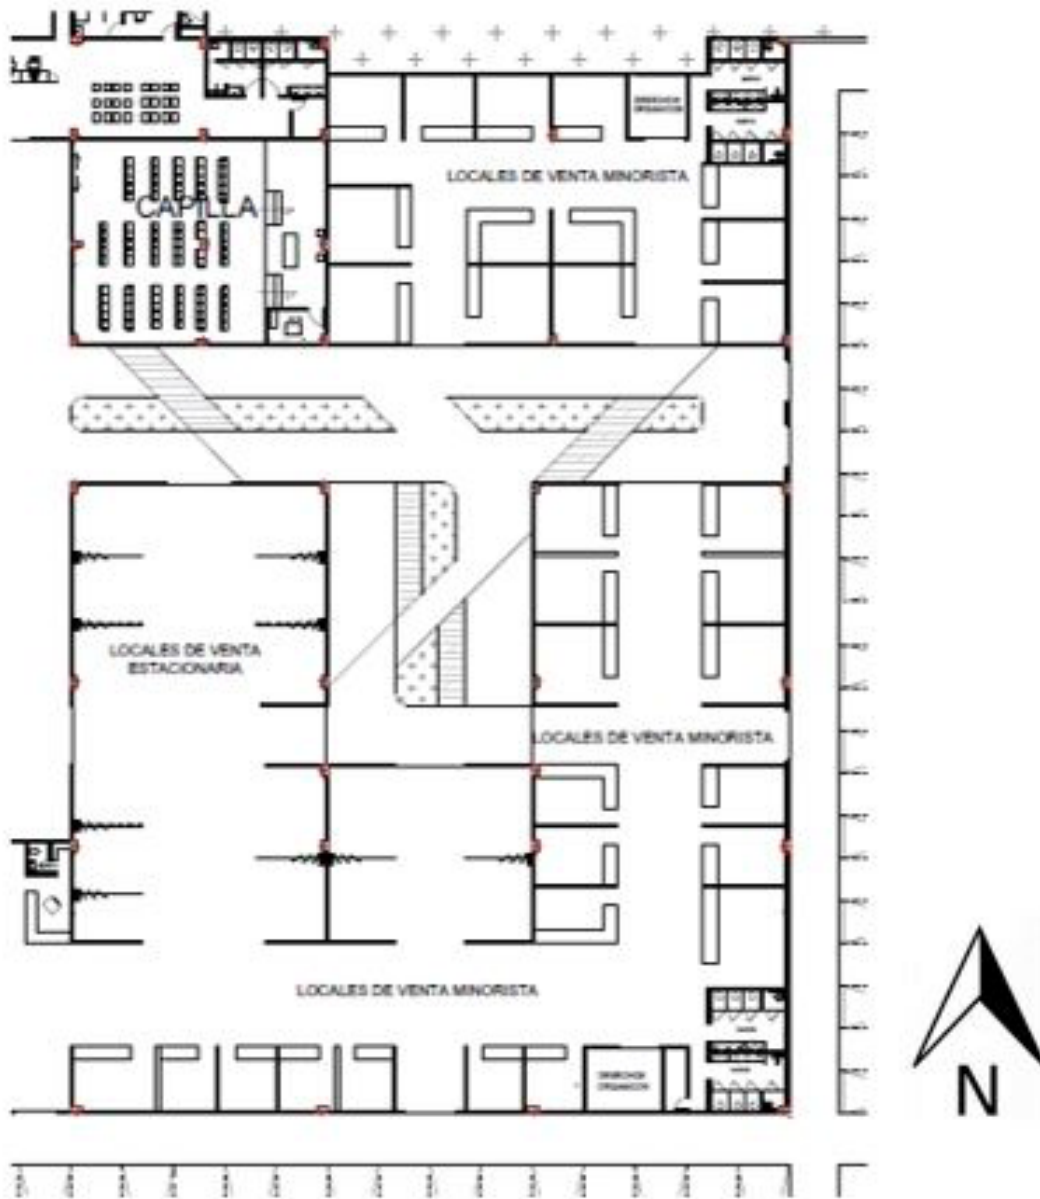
Planta primer piso Zona de Minorista y Venta estacionaria.
